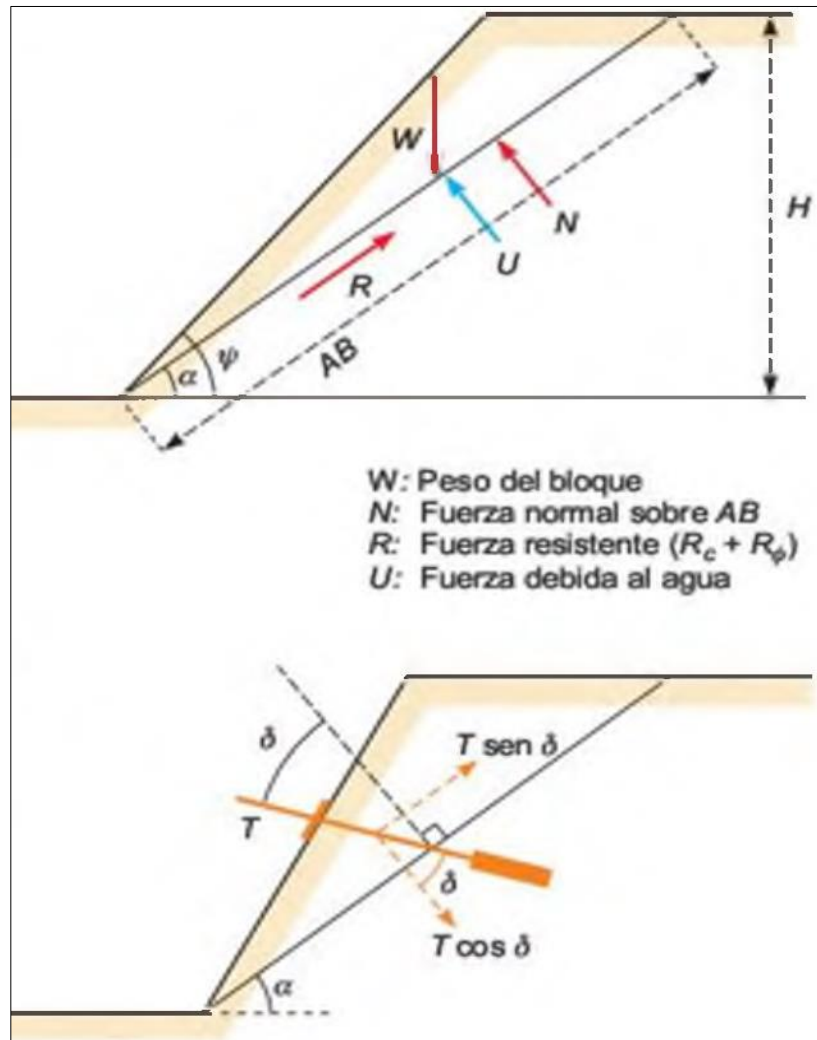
Esquema del modelo de las fuerzas actuando sobre un plano, rotura planar
